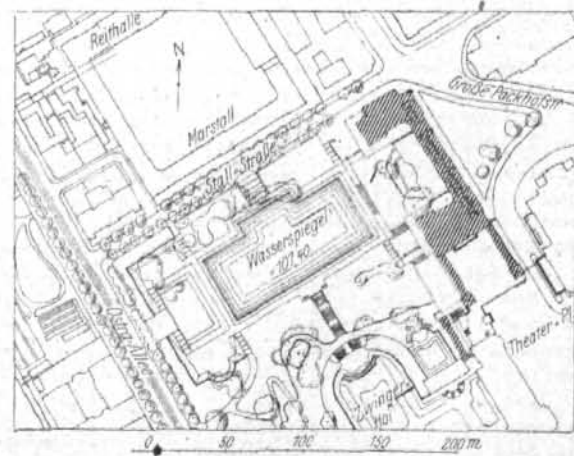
Lageplan mit der geplanten Gemäldegalerie.
